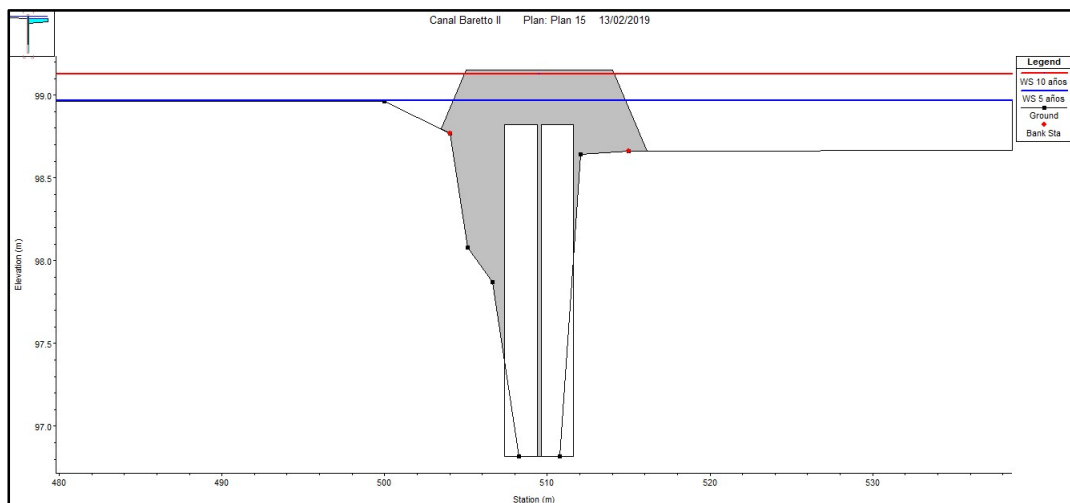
Perfil Transversal Alcantarilla 1 (TR = 5 y 10 años).
